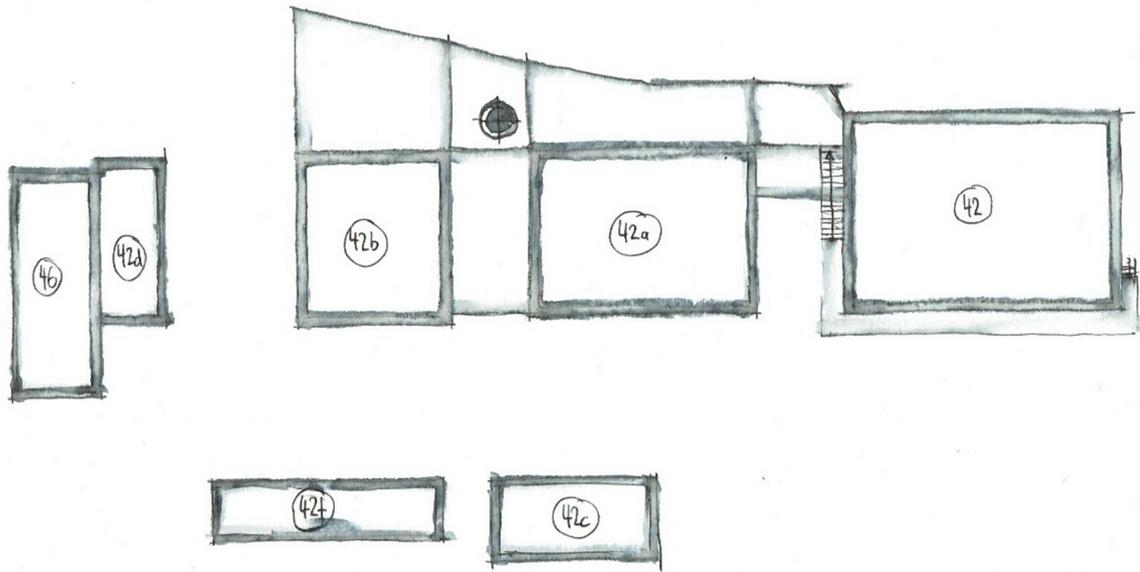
Skizze Arealübersicht, Grundriss
